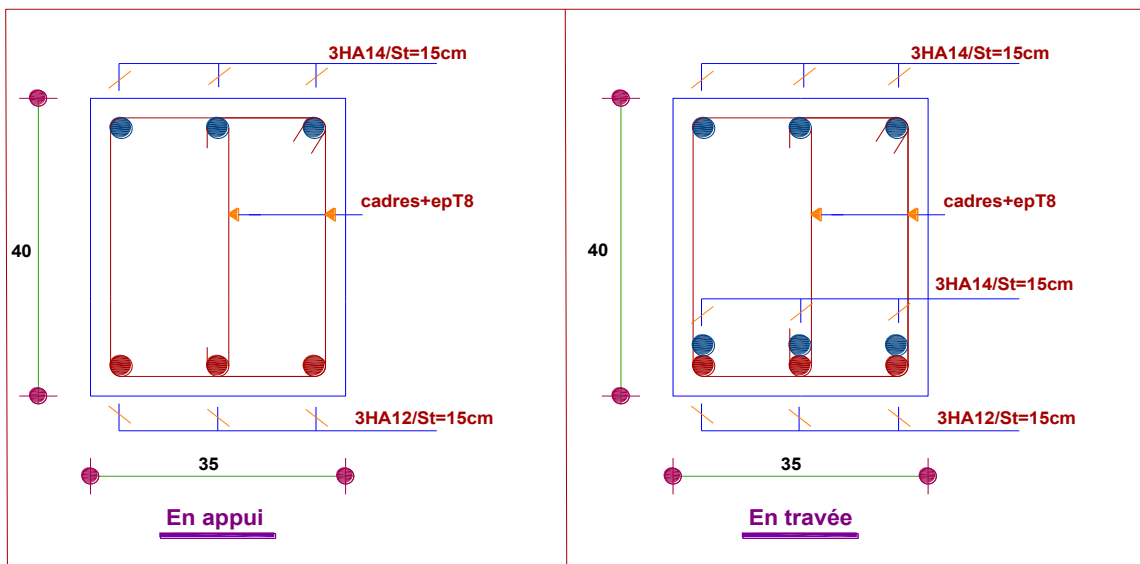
schémas de ferrailage de la poutre de chaînage.
